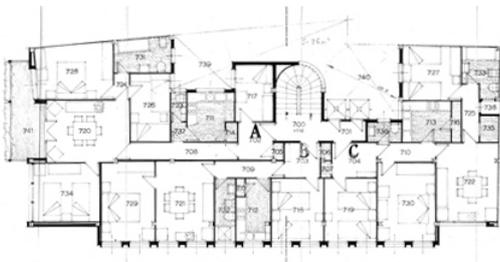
Planta de viviendas del Edificio Ros. Fuente: COACV
